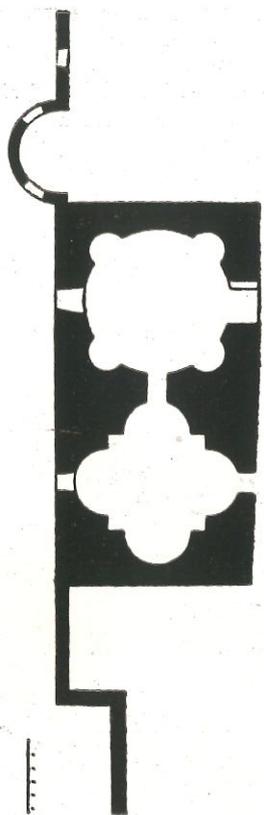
Planta de las salas cubiertas con cúpula de las ruinas de destinación indeterminada de Centcelles (Tarragona).
